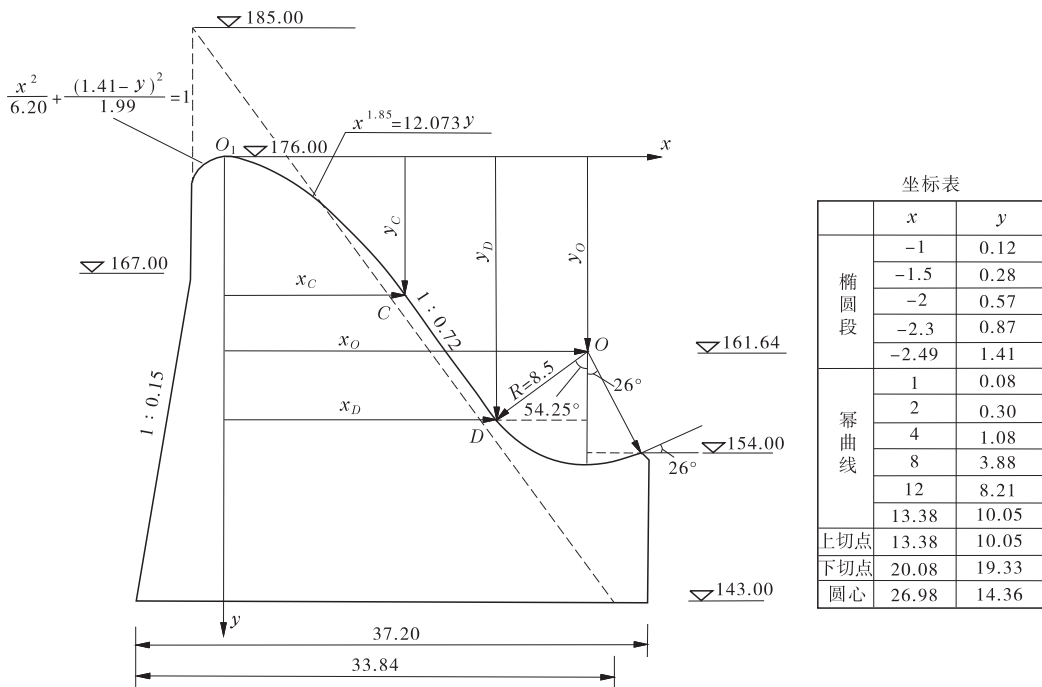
溢流坝切点、圆心坐标及剖面图 (单位:m)
